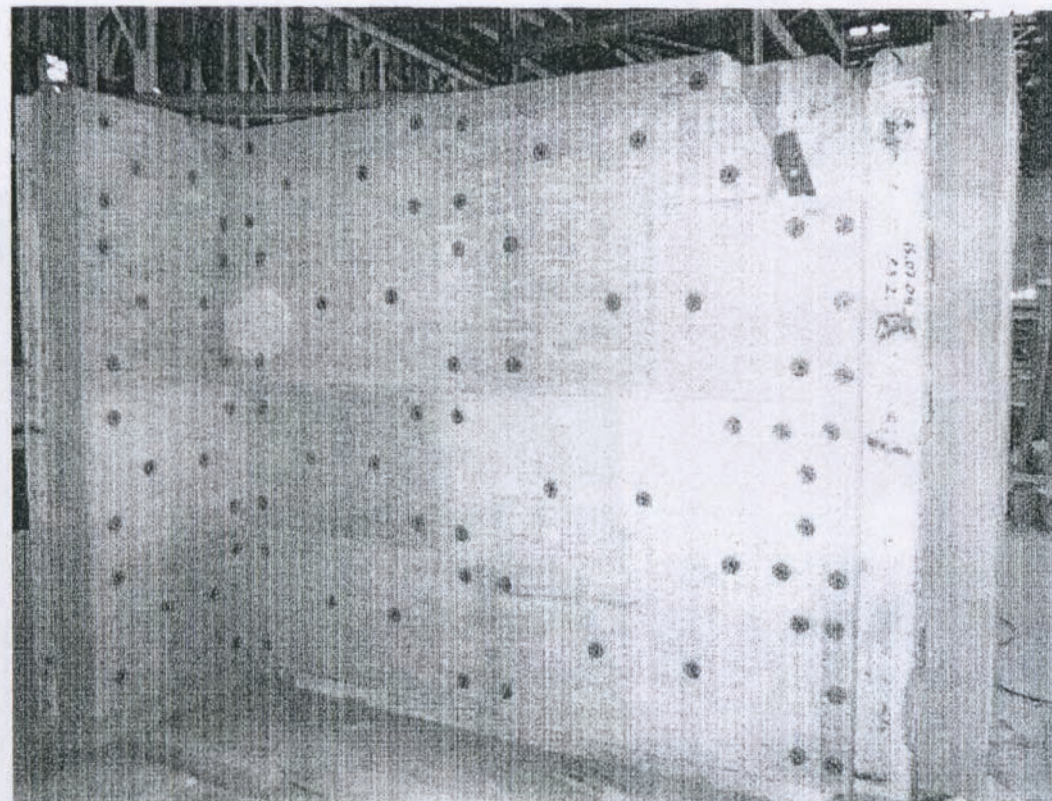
Общий вид железобетонного стенда с закрепленными на нем теплоизоляционными плитами.
